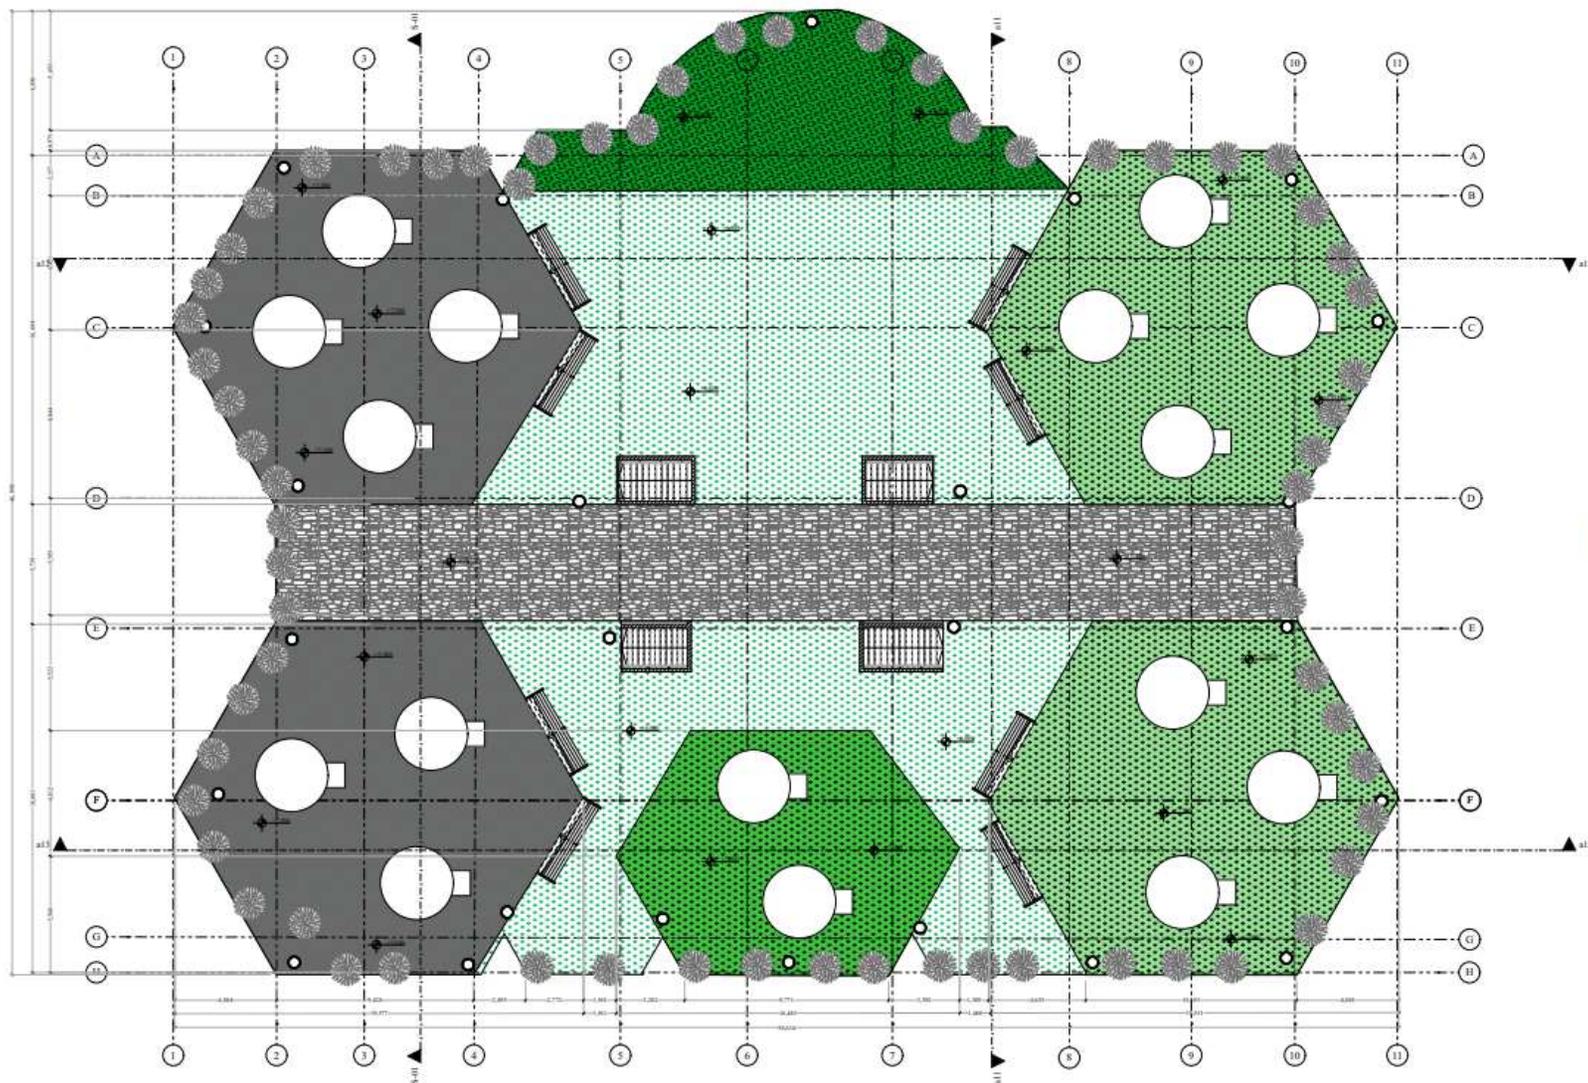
planta cimentación bar. Fuente: elaboración propia
